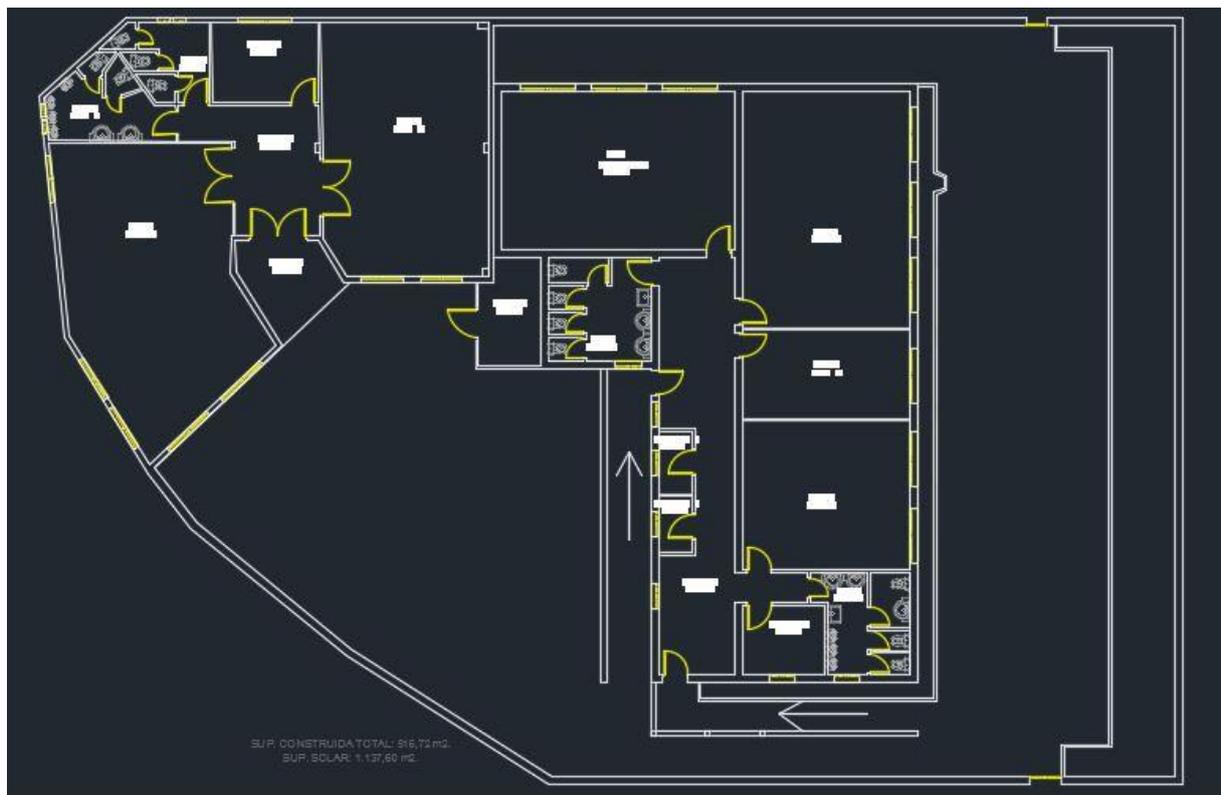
Plano *PLANTA - DISTRIBUCIÓN*.
